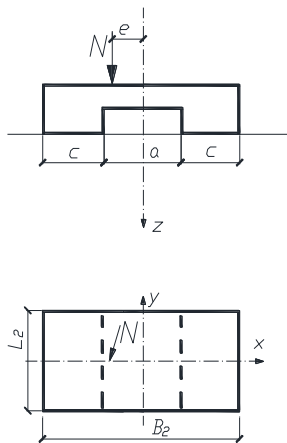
Внецентренно нагруженный фундамент жесткой опоры с вырезом по подошве
